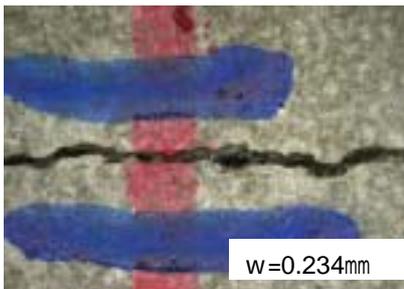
配合 6 養生条件 A ひび割れ導入
